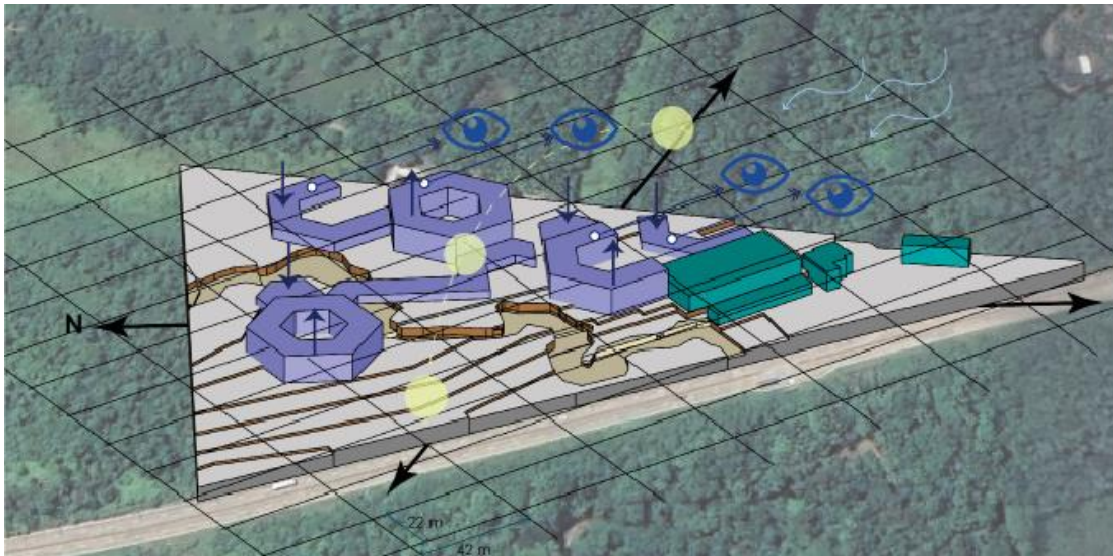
Geometría formal de la propuesta de implantación 2
